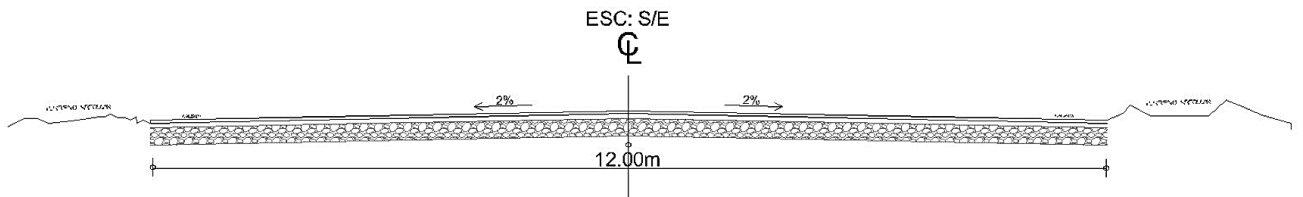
Sección transversal existente elaborado por (Morales 2022)
